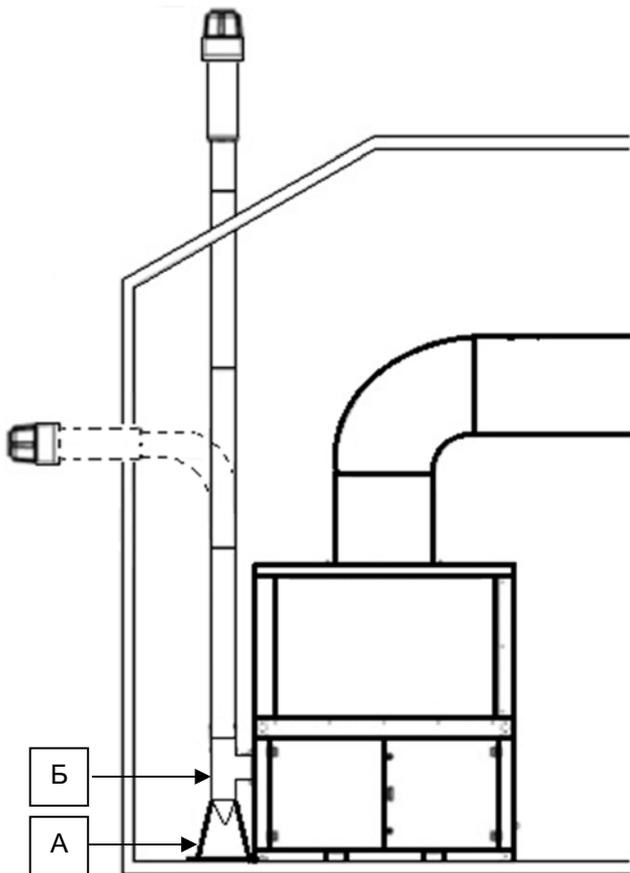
Расположение воздухонагревателя внутри
